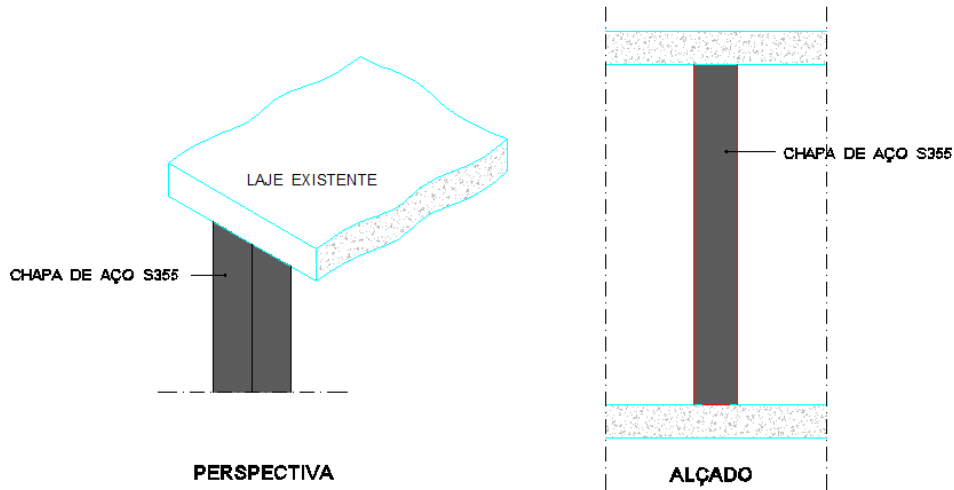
Reforço de pilares com chapas metálicas (hipótese inicial) [42]
